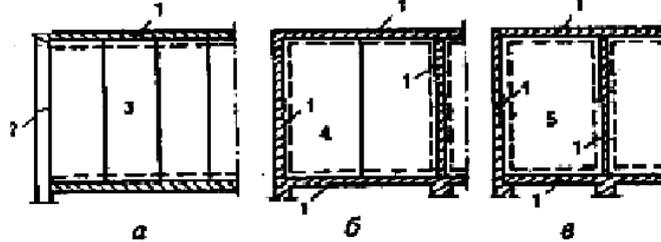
Размещение плит перекрытия в планировочно-конструктивной системе здания:
